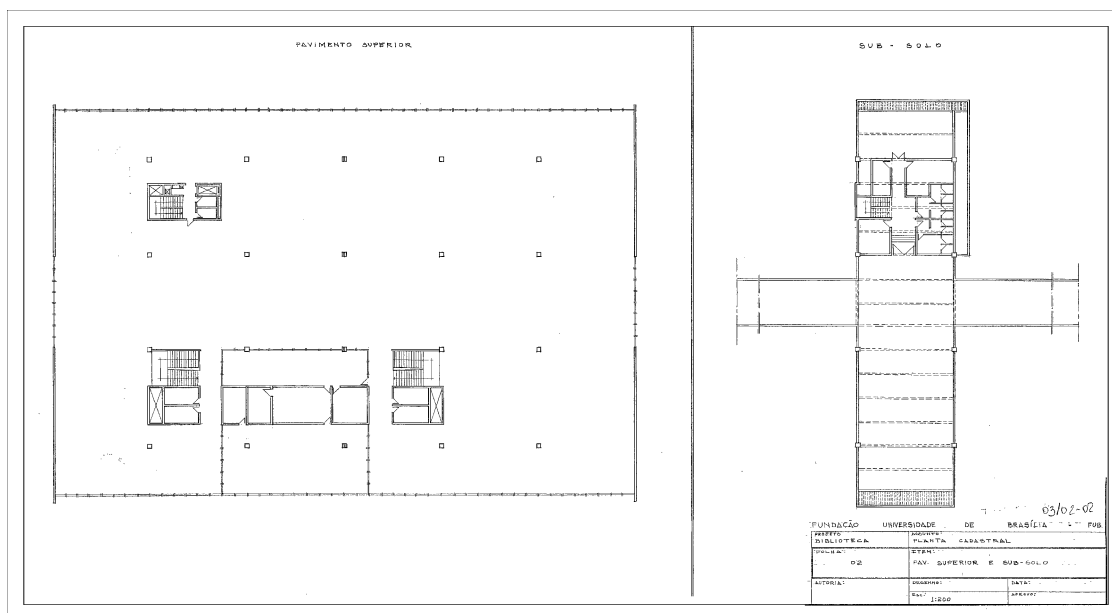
Plantas do pavimento superior e subsolo (CEPLAN).
